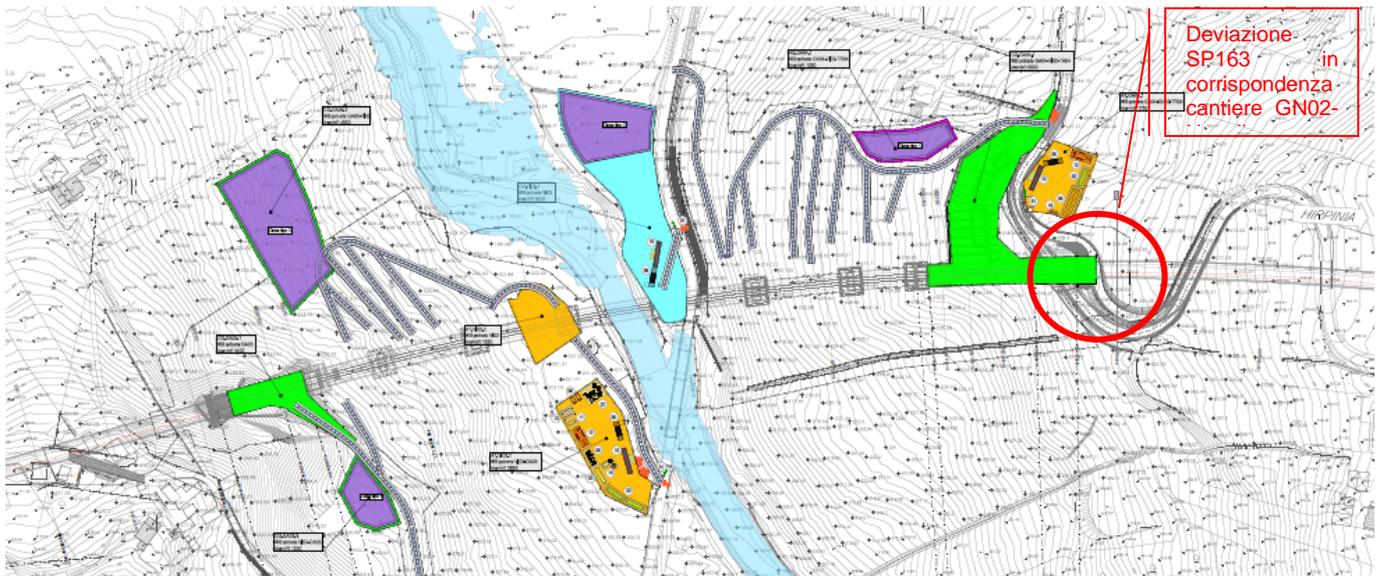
Layout cantieri VI03 – Imbocchi gallerie Rocchetta Bari e Melito Napoli
